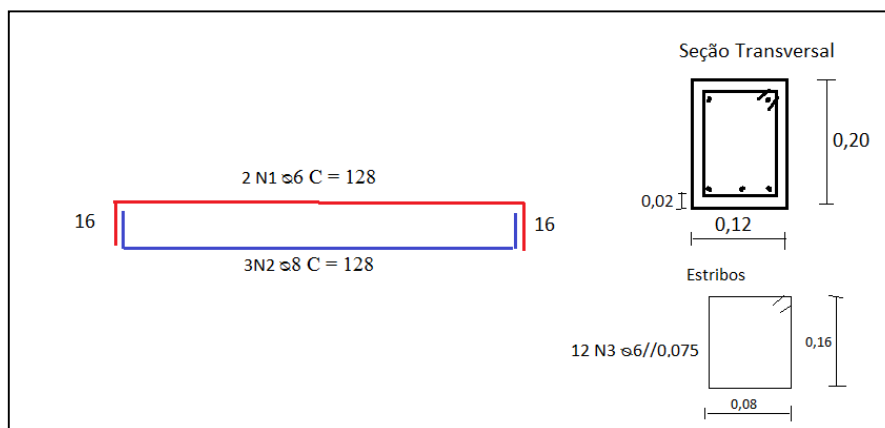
Armação longitudinal e transversal das vigas de estudo.
